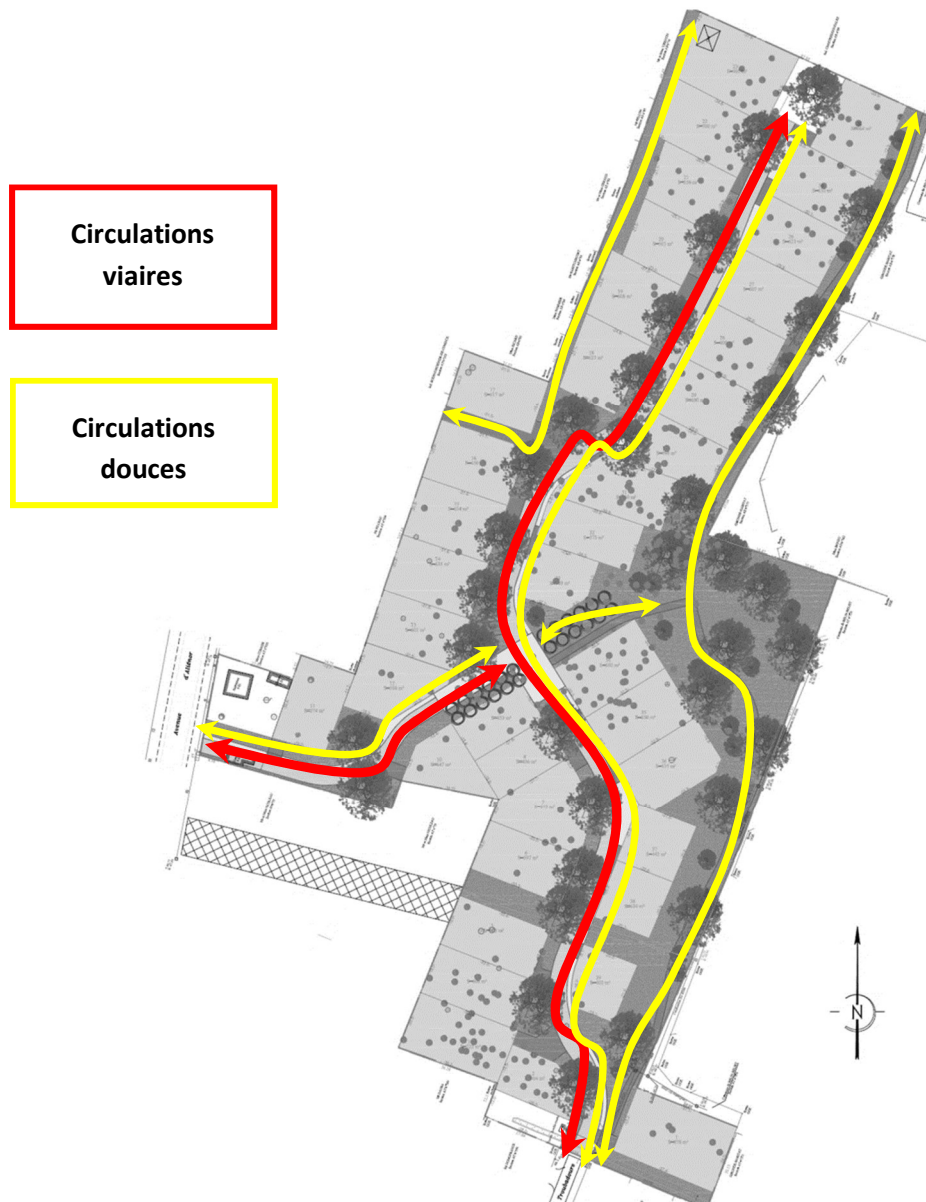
Circulations du projet (Source : Plan de masse-AUIGE)
